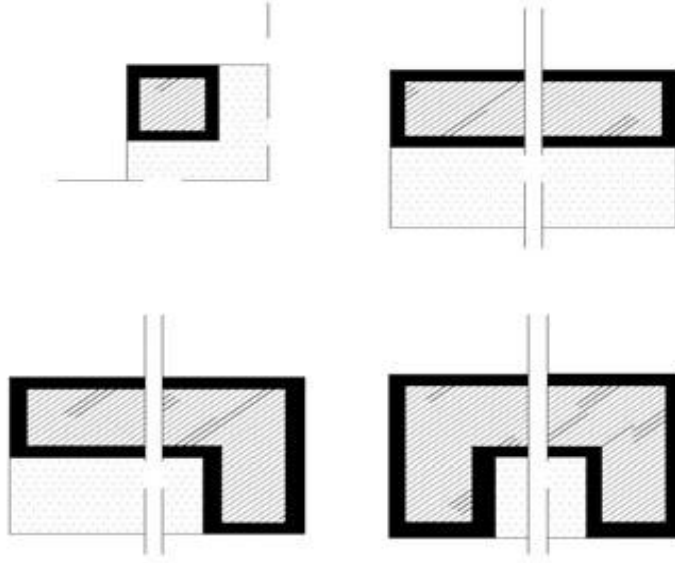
Sofasız Plan Tipi (Bektaş 1996)
